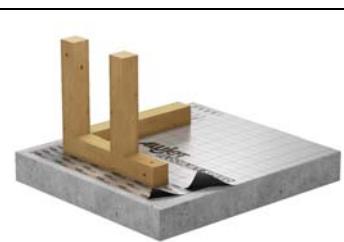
ALUJET Floorjet SPEED (matt) / ALUJET Walljet ALU
